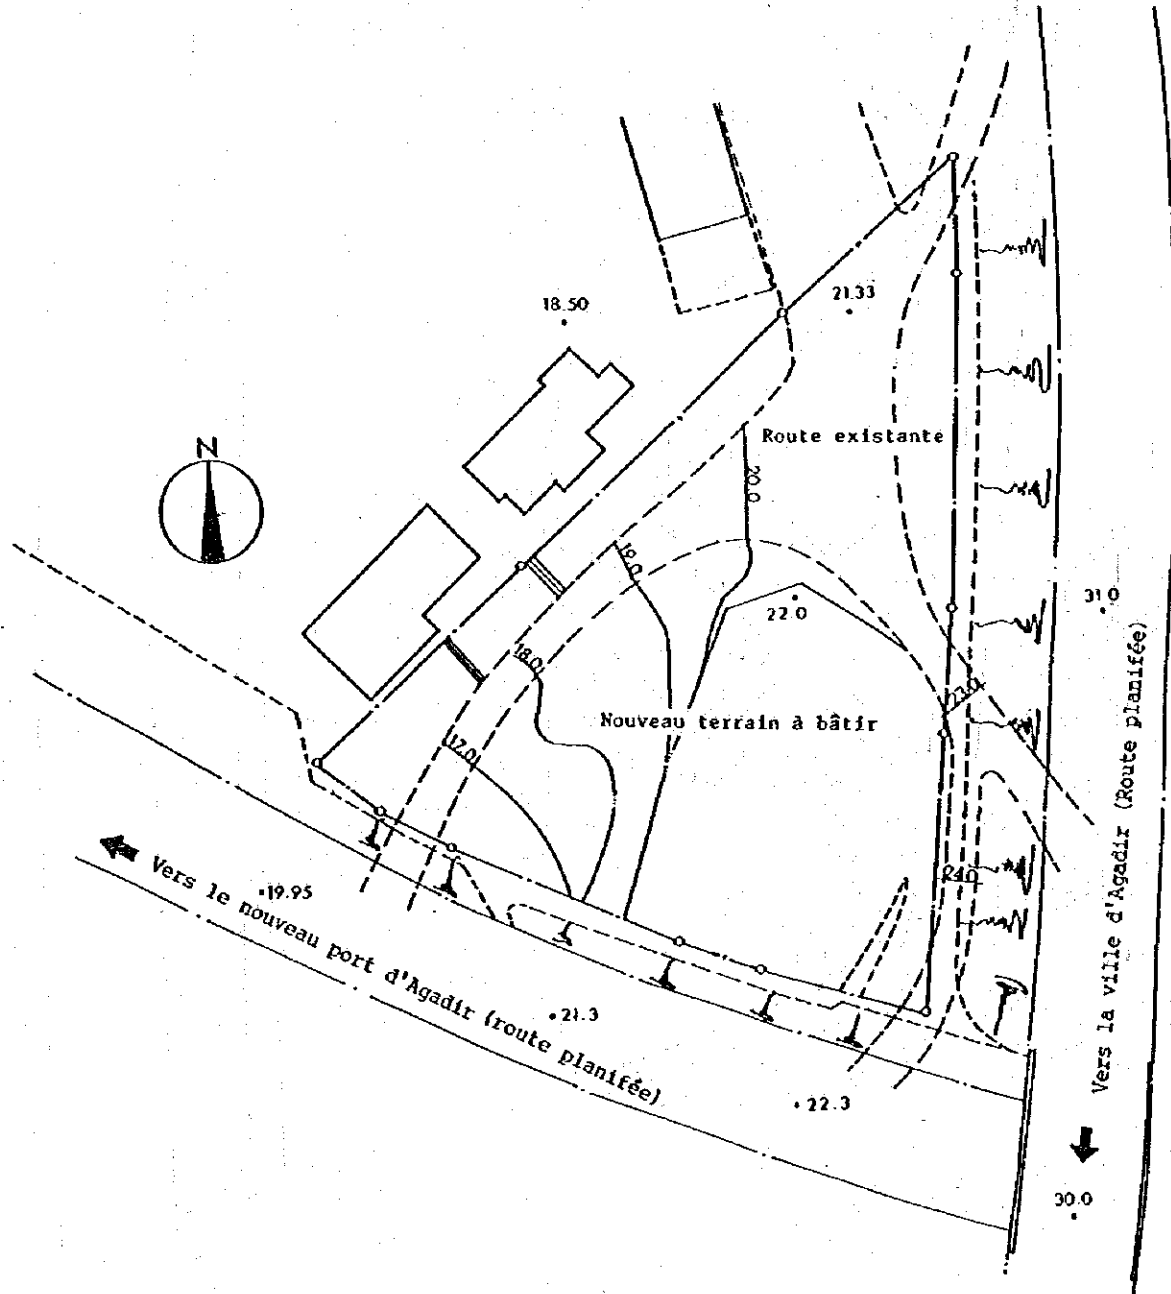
Plan côté du nouveau terrain à bâtir (plan sommaire)
